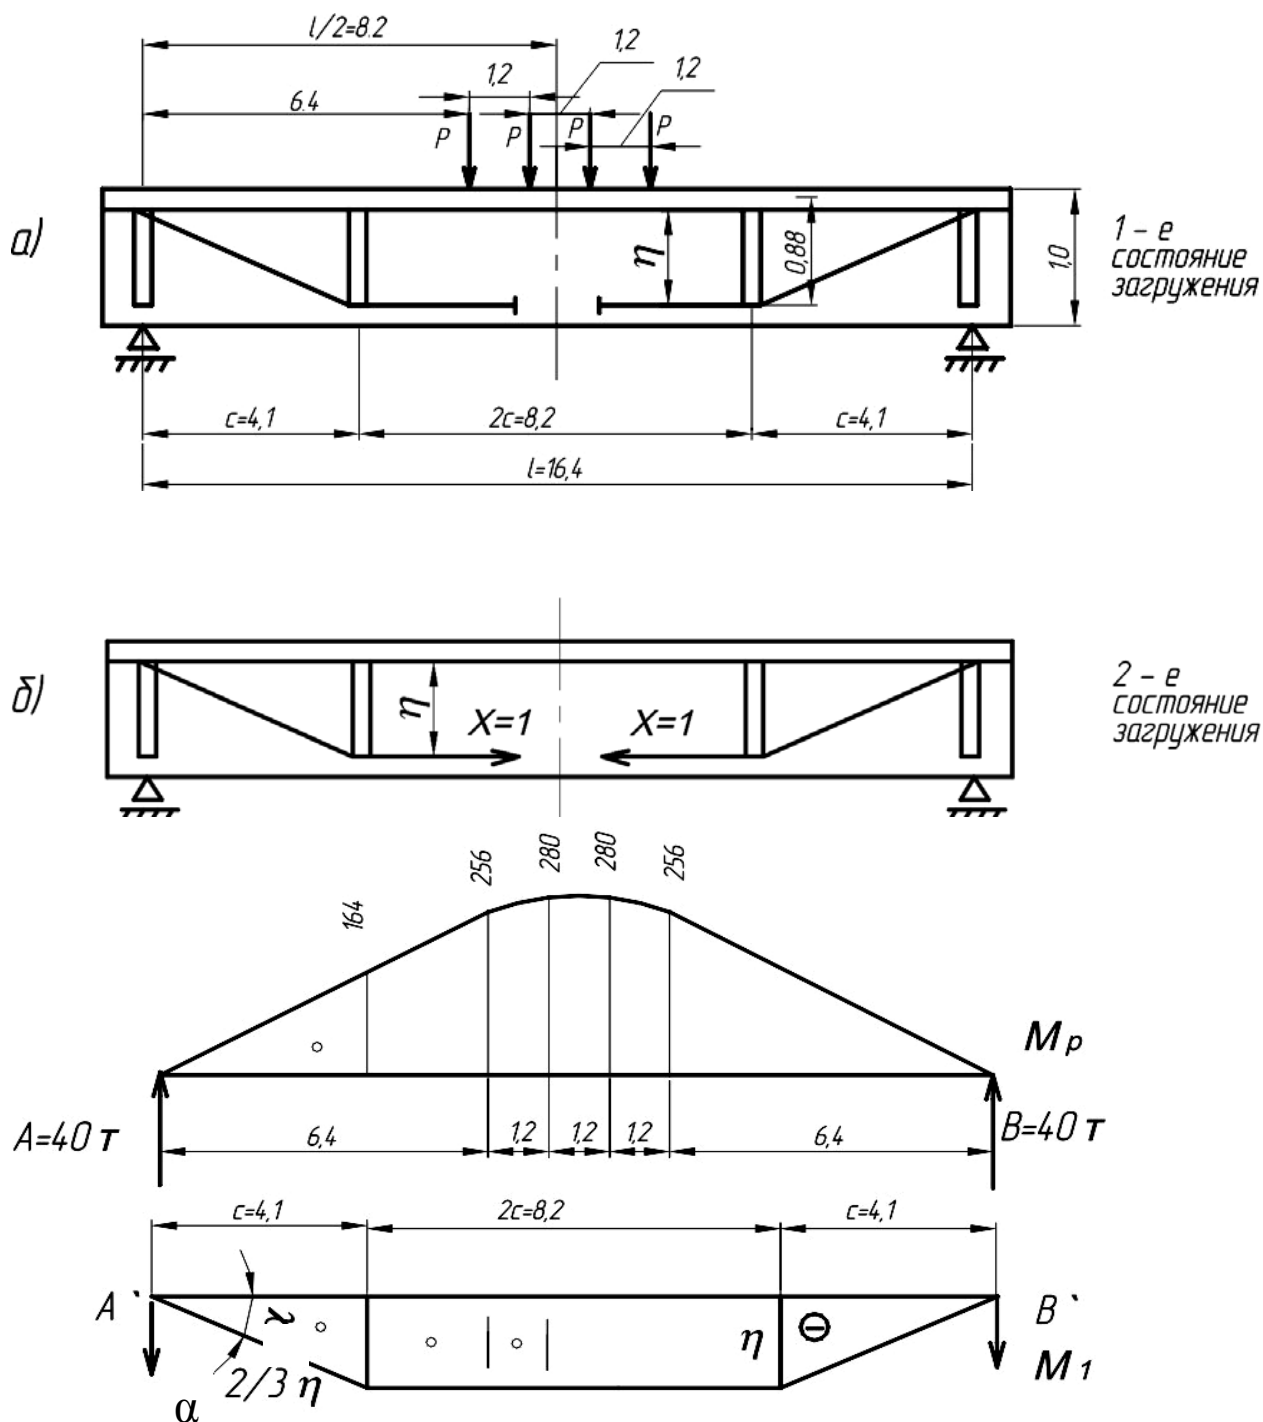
Схема расчета балки, усиленной шпренгелем
